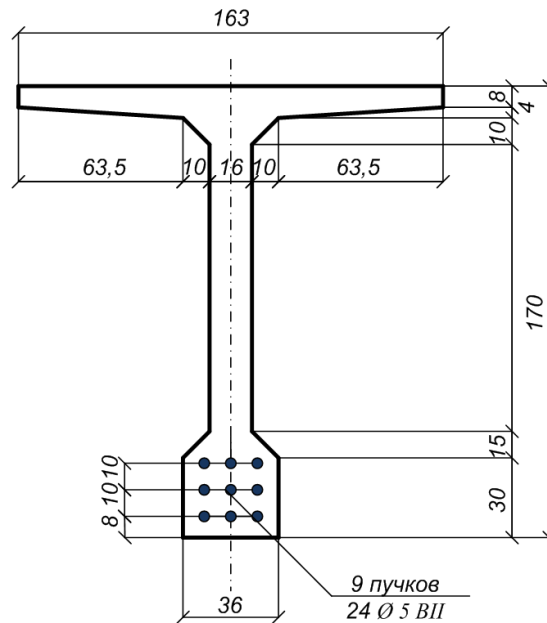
Сечение с размещением предварительно напряженной арматуры
